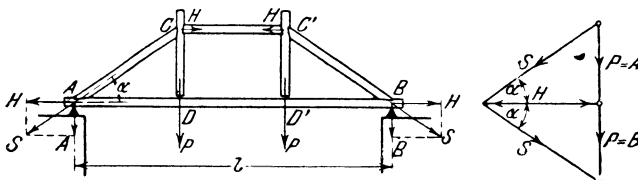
Zweifaches Hängwerk. (Aus Gesteschi, Dachkonstrukt.)
